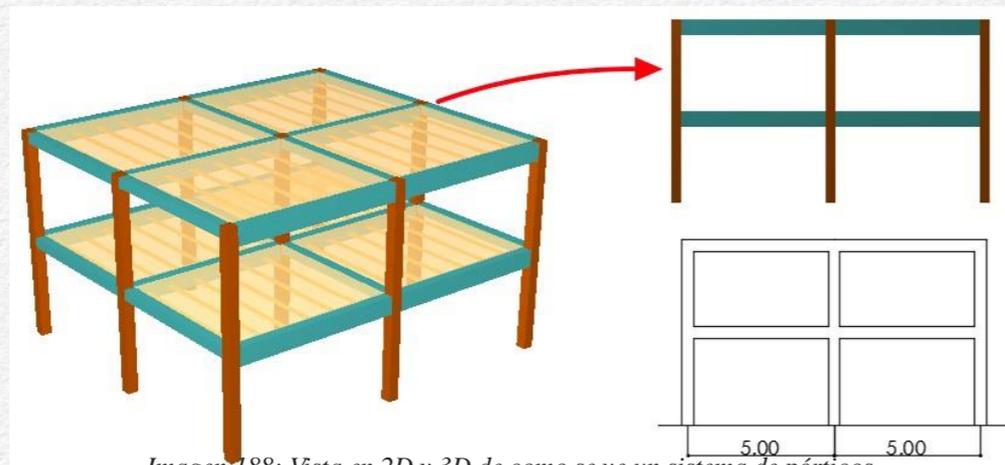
Vista en 2D y 3D de como se ve un sistema de pórticos.
